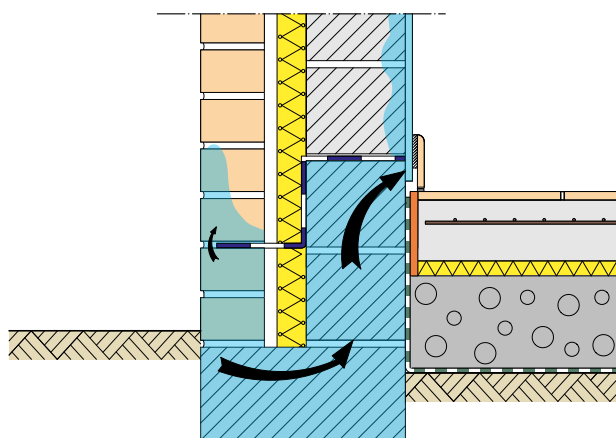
Pontage de la membrane d'étanchéité par l'enduit intérieur et par le joint de parement (coulisse isolée thermiquement ou non).
